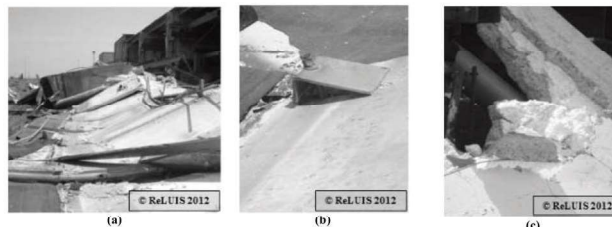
(a) Crollo dei pannelli verticali di tamponamento; (b) dettagli profili della quadretta e del bullone ancora inserito nel profilo a C del pannello crollato e (c) dettaglio sezione trasversale del pannello verticale, costituito da calcestruzzo armato e materiale di alleggerimento e isolante
